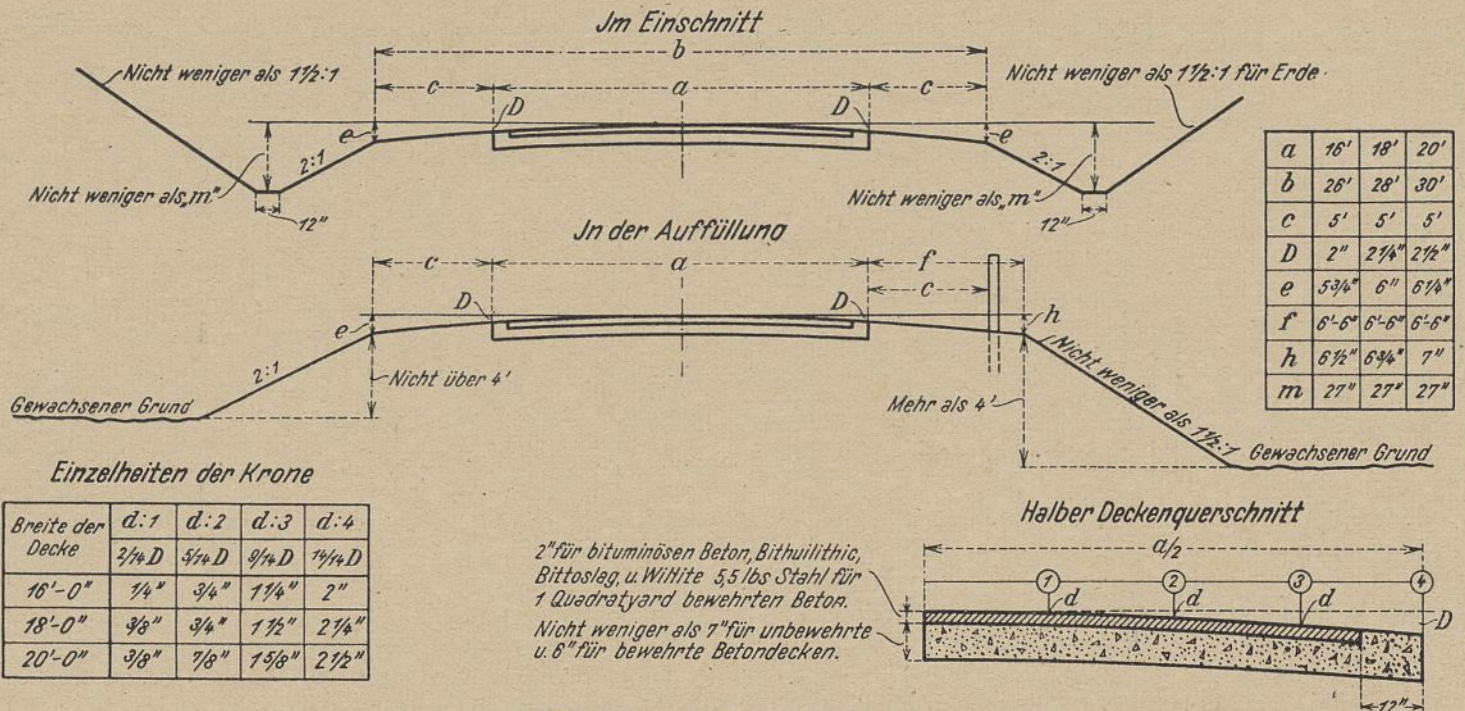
Standardplan für bituminösen Beton. Ohio 1923. Zu I.
